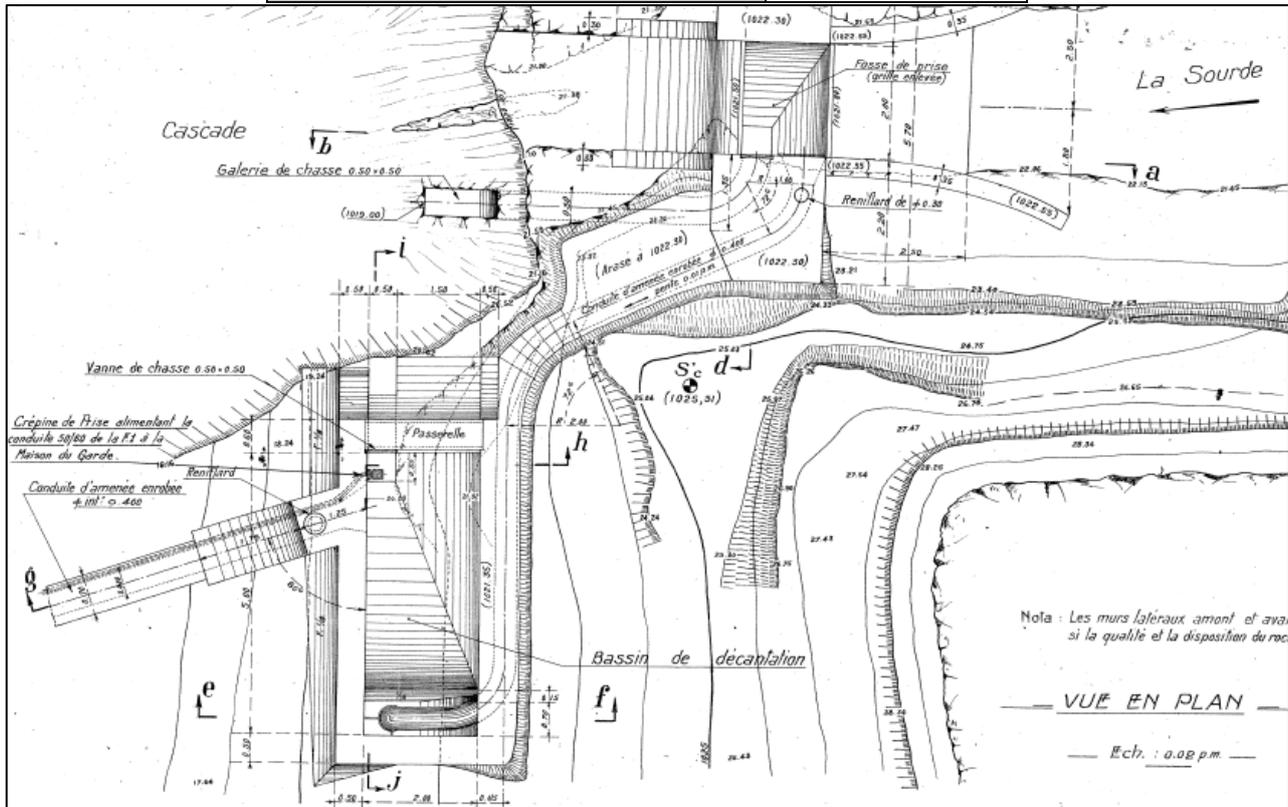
Vue en plan de la prise d'eau de la Sourde
